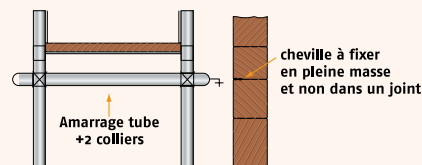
Amarrage en ligne (voir également la notice d'instruction, de montage du fabricant)
